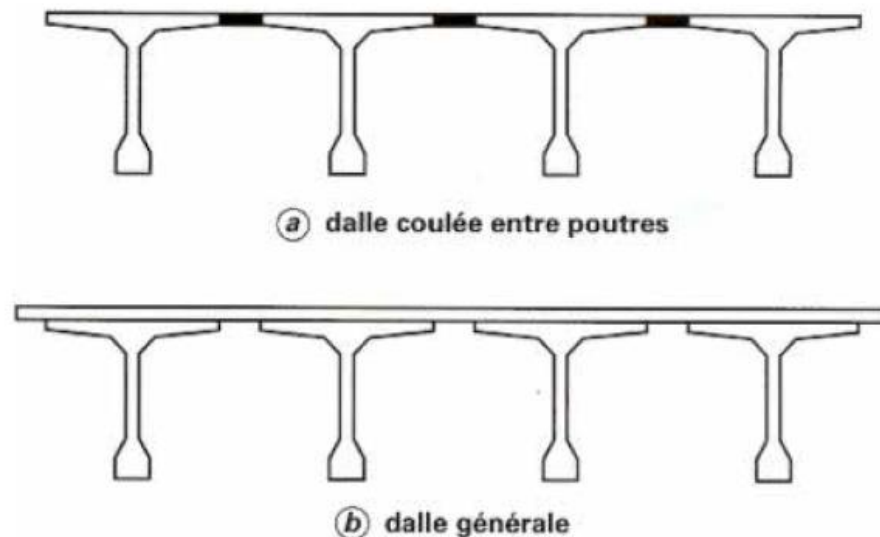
Conceptions possibles d'un tablier de pont à poutres précontraintes.
